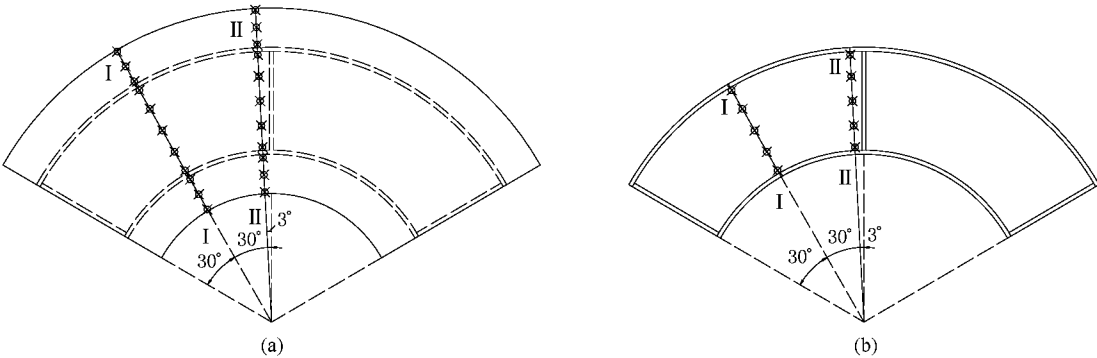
测点布置平面图 (a)顶板测点布置位置图,(b)底板测点布置位置图
